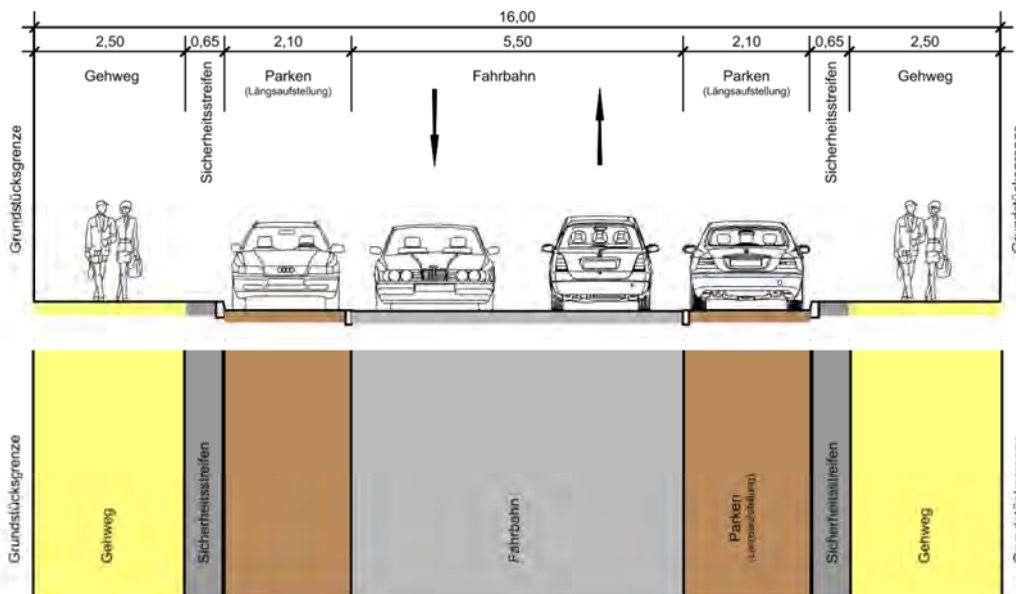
Variante B Planstraße mit beidseitigen Längsparkständen
